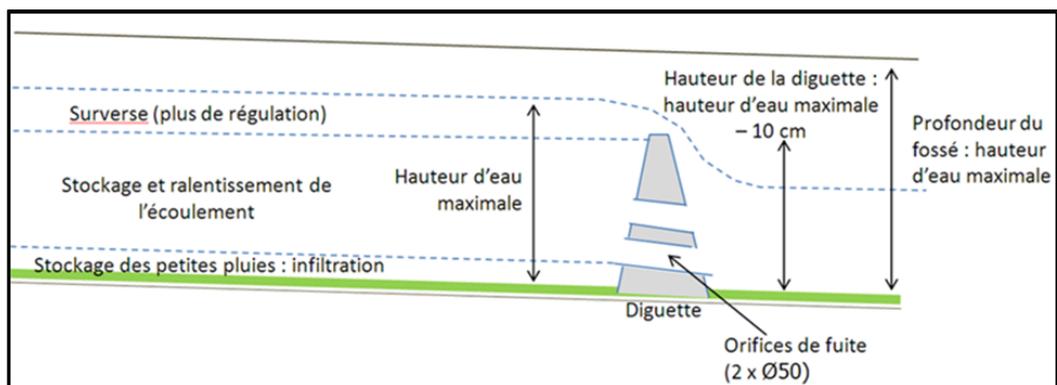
Coupe longitudinale standard d'un redent (Source : BURGEAP)
